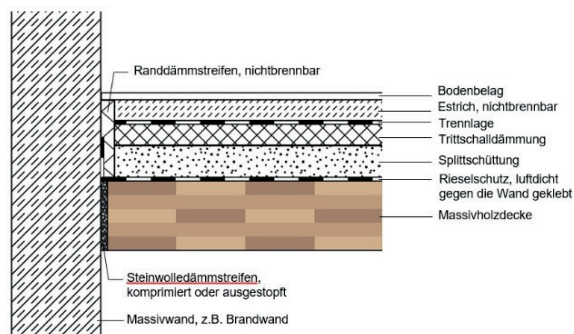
Stahlbeton, z. B. für Brandwände, kann im Holzbau sowohl der Aussteifung der Tragwerkskonstruktion als auch dem Brandschutz dienen. (Quelle: M-HolzBauRL)
